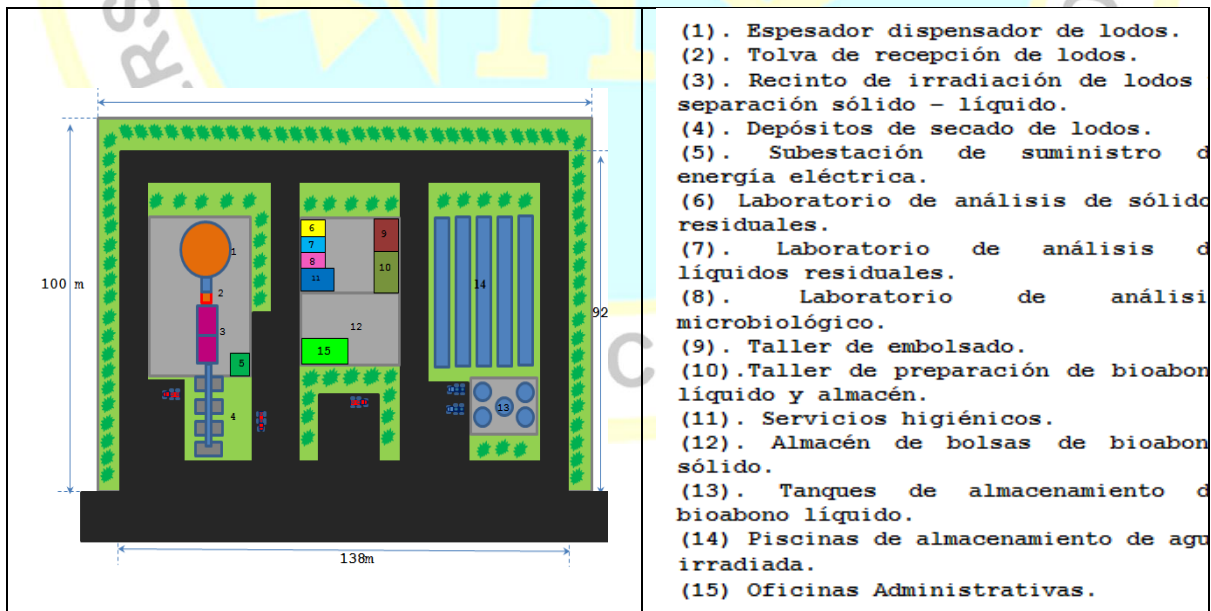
Area donde se construirá la planta de tratamiento de lodos.
